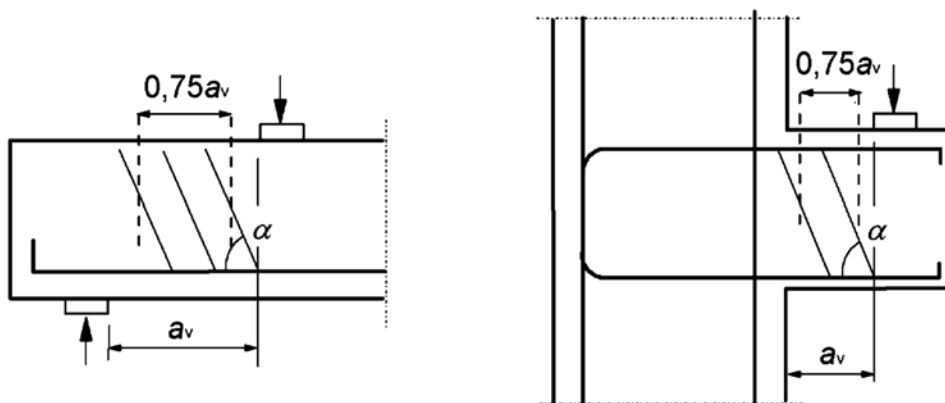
Поперечна арматура на зсув у коротких прольотах при безпосередній дії на умовний стиснутий елемент
